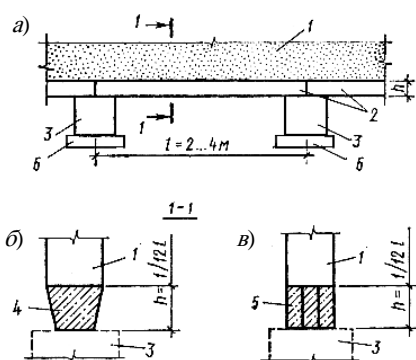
Конструктивные схемы фундаментных балок столбчатых фундамента:
